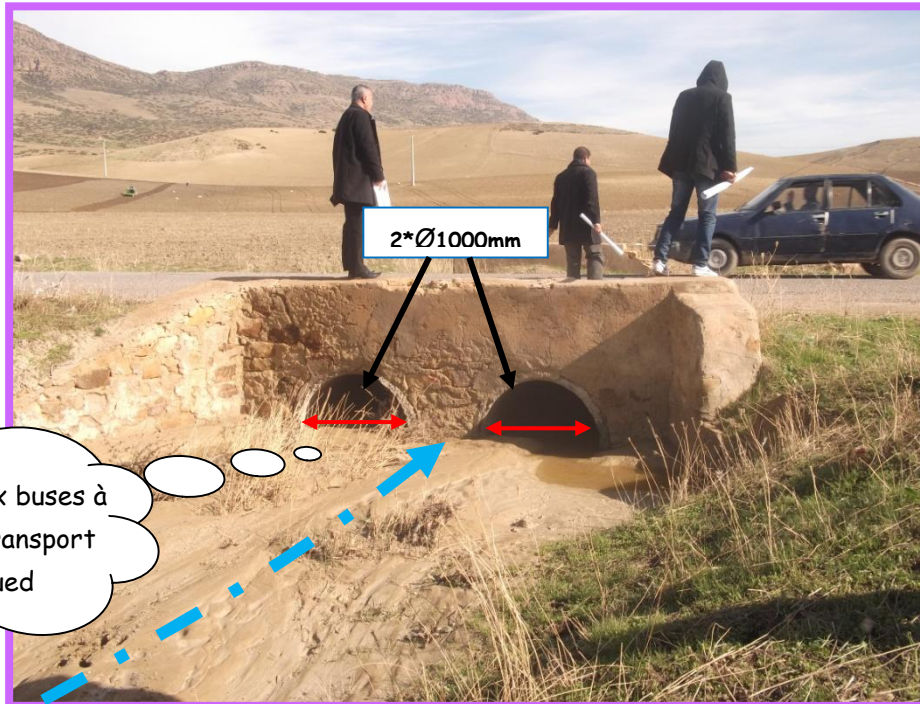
prise à l'aval de l'ouvrage de traversée.
